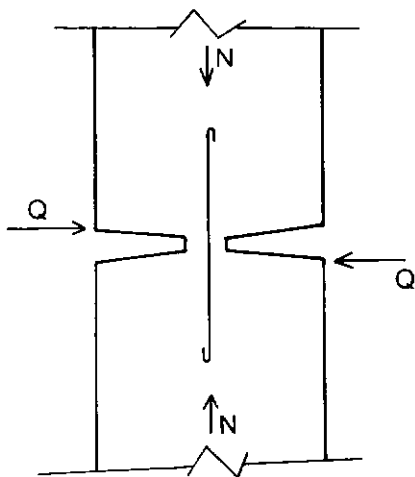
ARTICULAÇÃO DE CONCRETO ARMADO
